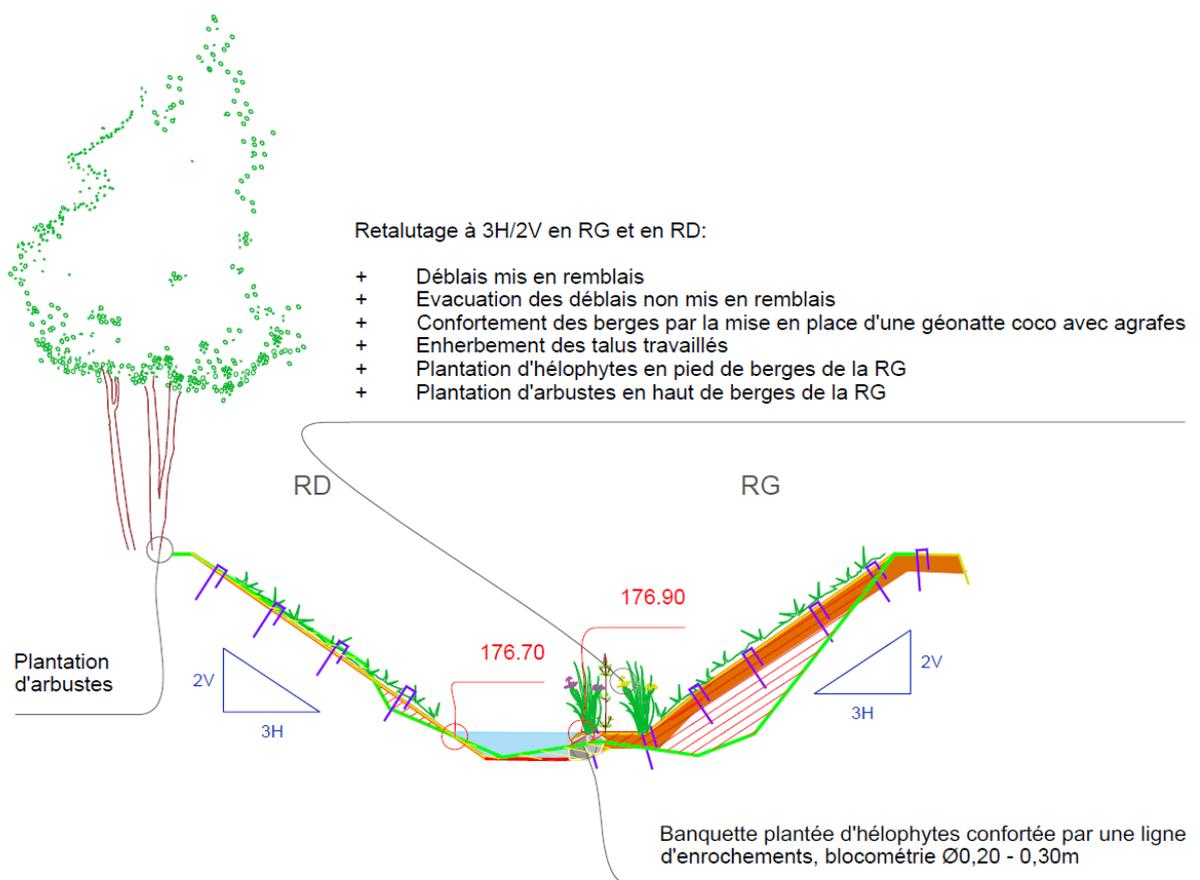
Coupe sur profil 11 représentative du lit projeté du bras Sud
